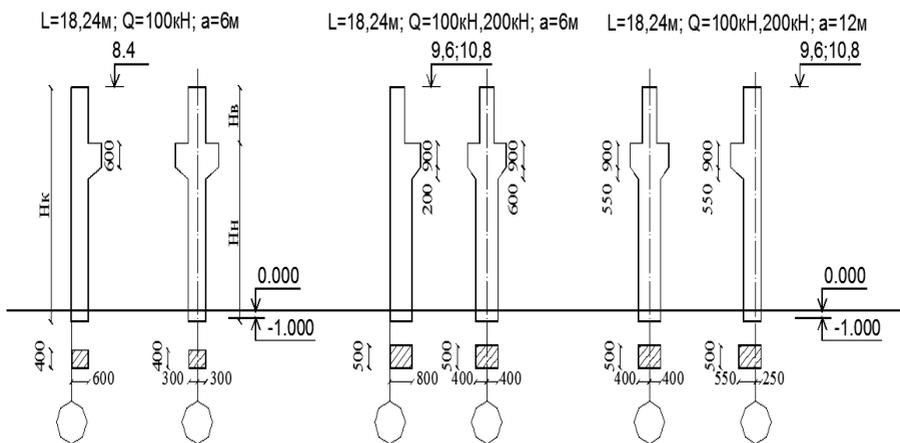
Железобетонные сплошные колонны для крановых зданий
